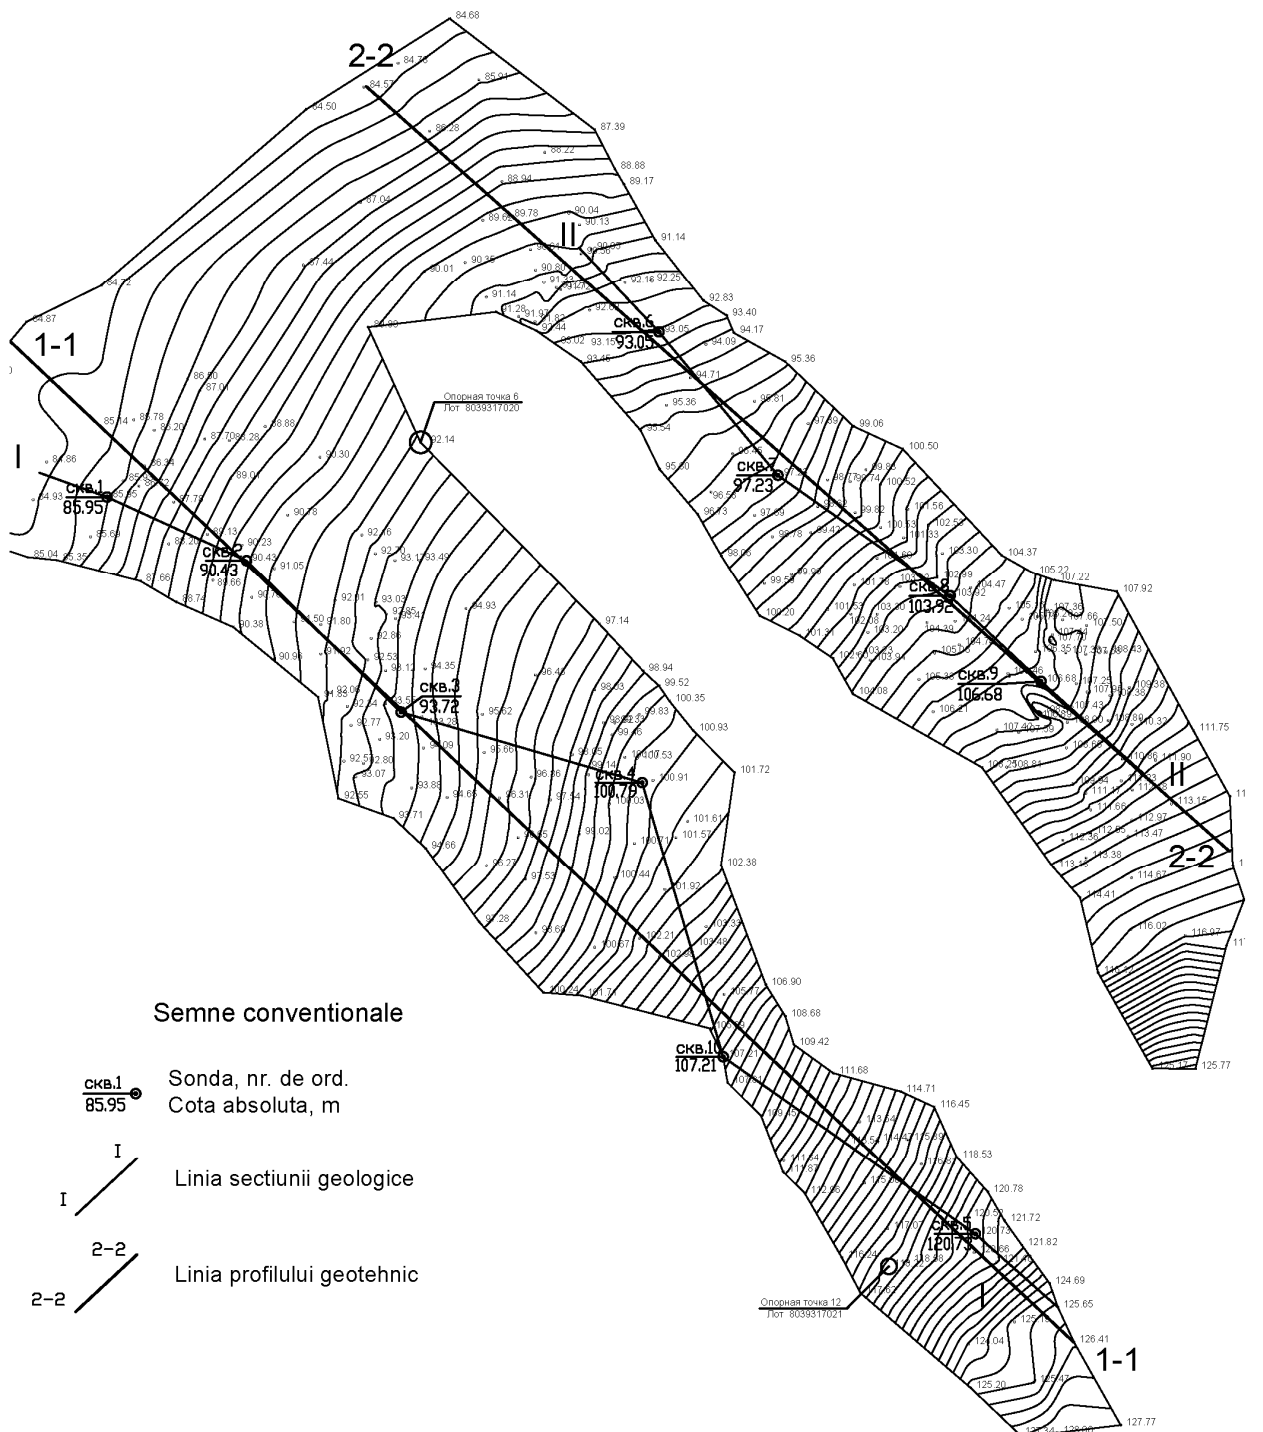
Terenul nr.4 „Construcția complexului locativ din satul Trușeni, mun.Chișinău”
